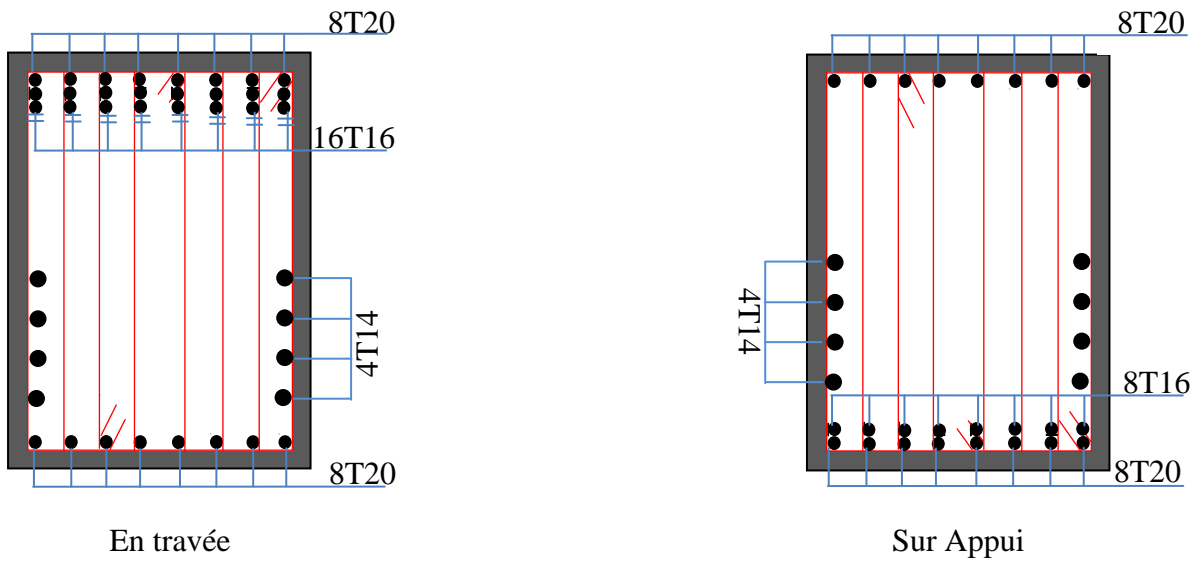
schéma de ferrailage de la poutre de libage Sens longitudinal (y).
